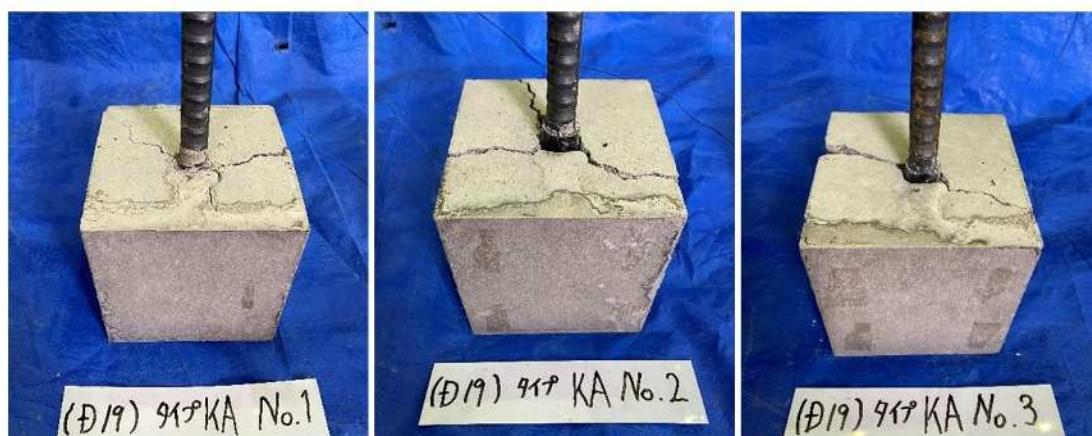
試験後の供試体状況タイプ KA(D19)
